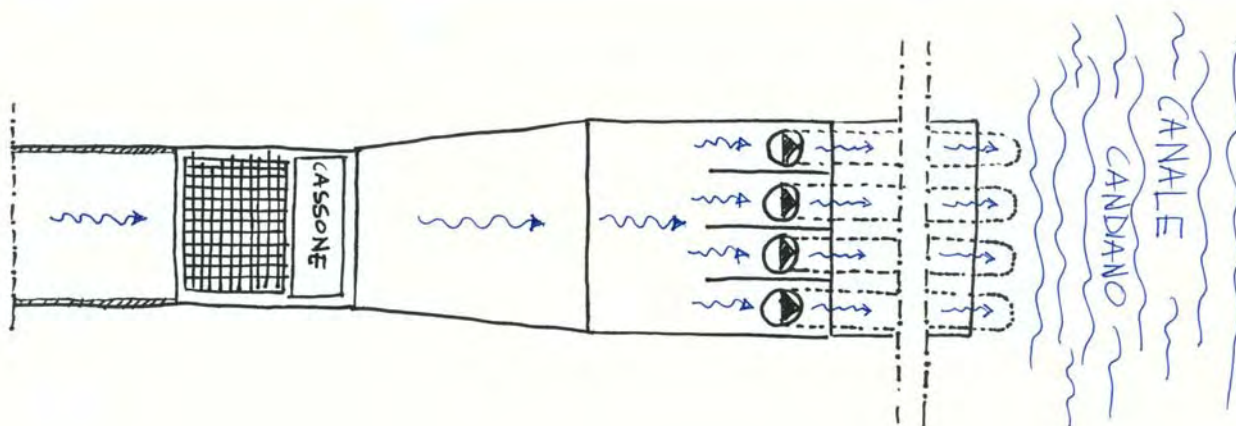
Impianto idrovoro, pianta dello schema tipo (S1-2-5-6)
